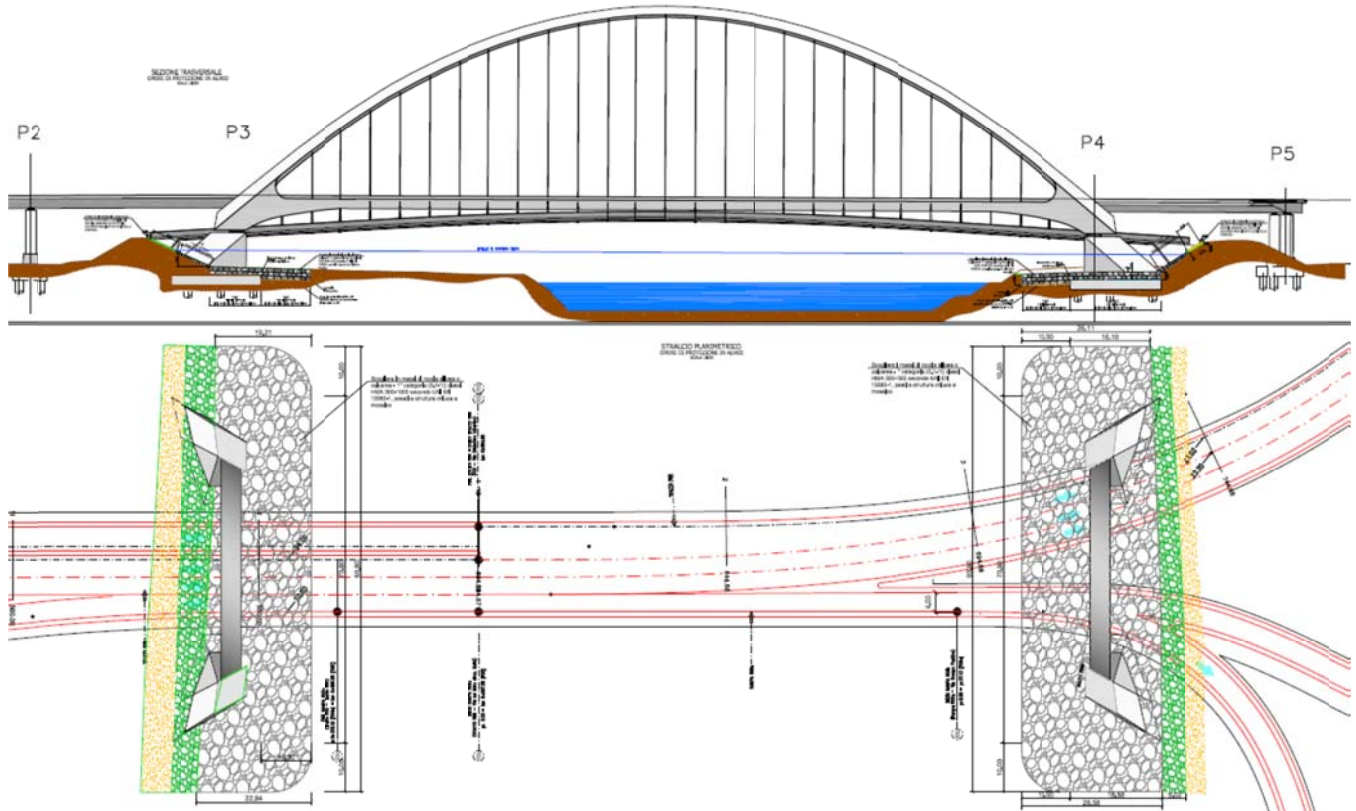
Attraversamento Fiume Tevere – Opere di presidio in alveo - Planimetria e sezione longitudinale
